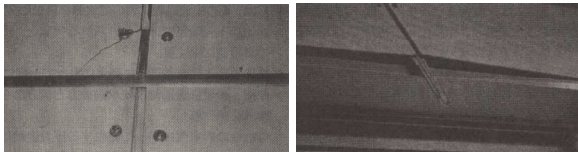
フレキシブルボードのひび割れ・浮きの状況例¹⁾
